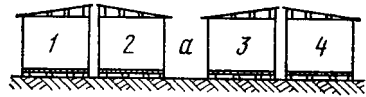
Схема направления скатов крыши: а — продольные проезды на складе; 1—4 — штабеля пиломатериалов
